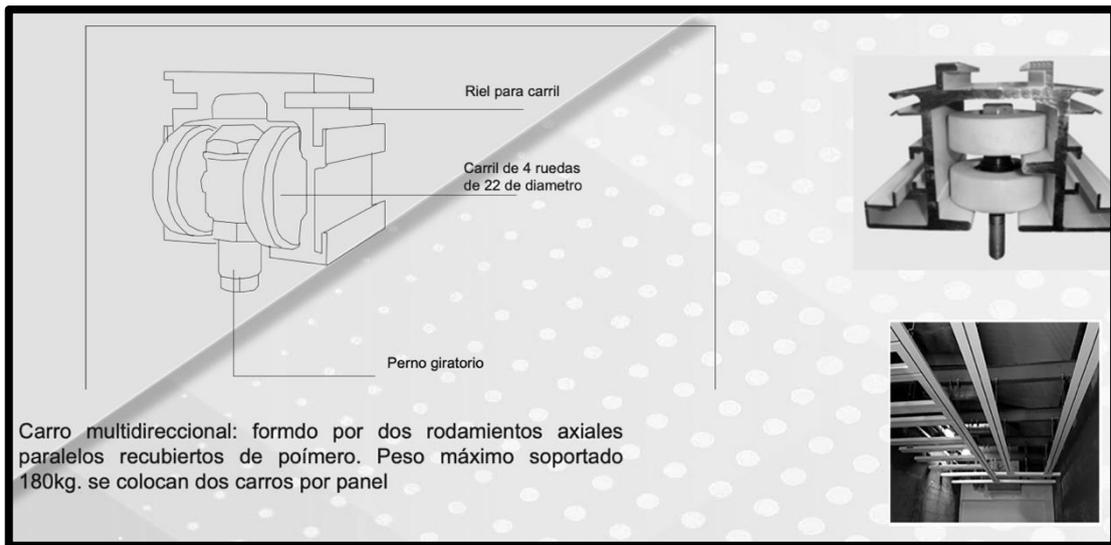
Detalle instalación de dirección y anclaje panel sensorial.
